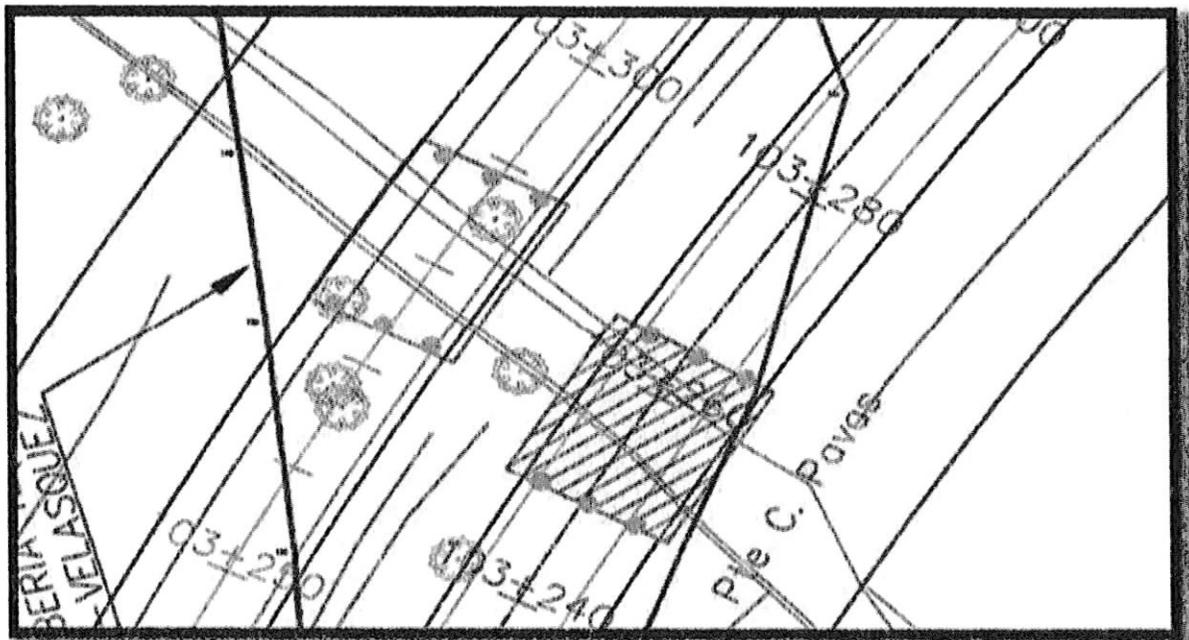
Acercamientos críticos con estructuras viales (Puentes) e infraestructura petrolera
